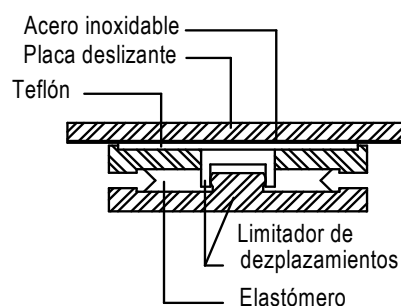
Esquema de un dispositivo aislador sísmico de base del tipo deslizante plano.
